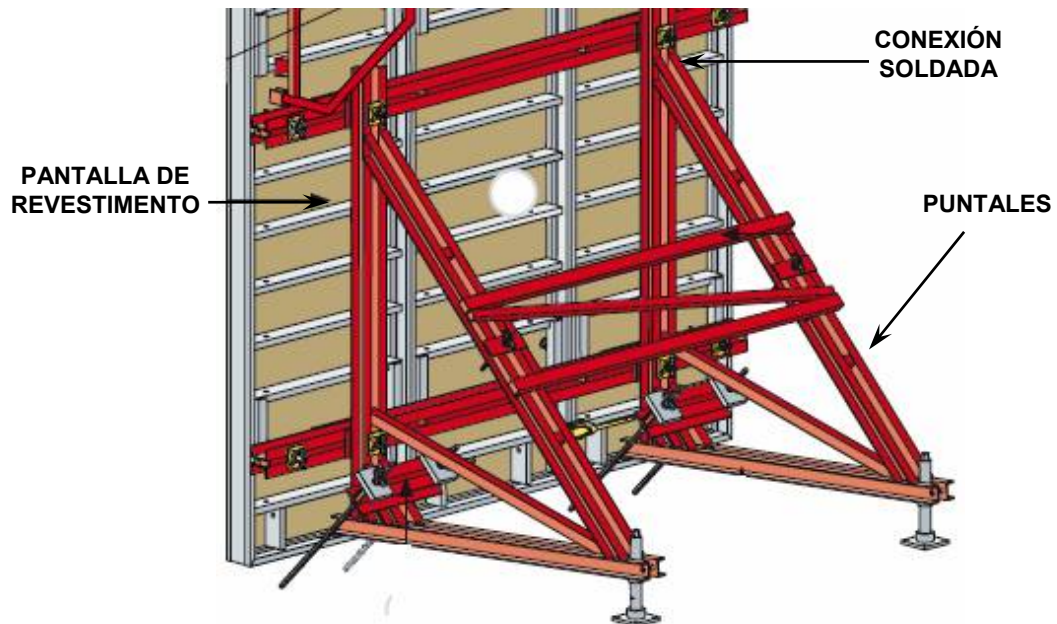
Conexiones por soldaduras en sistema de puntas inclinadas.
